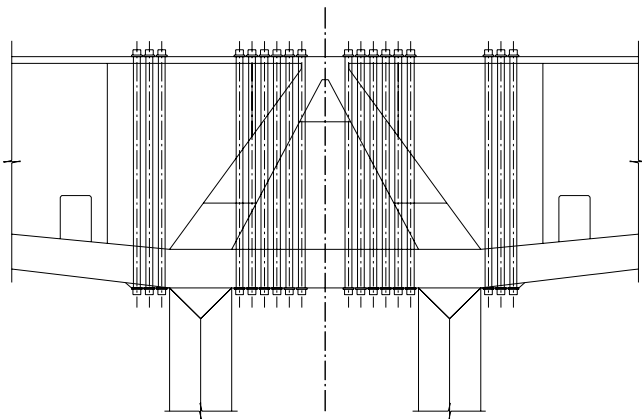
Pretensado vertical en la sección de apoyos para compensar la pérdida de armadura en las células triangulares por la ejecución de taladros necesarios para anclar el pretensado exterior.
